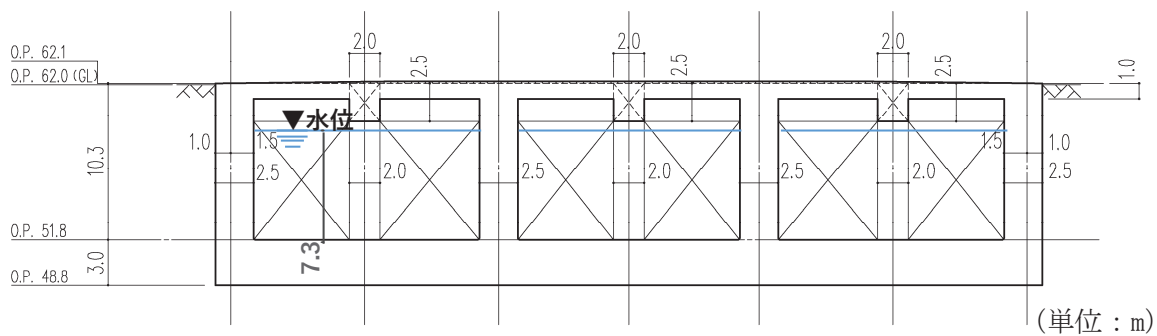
(1) 淡水貯水槽の概略断面図 (A-A 断面 EW 方向)
